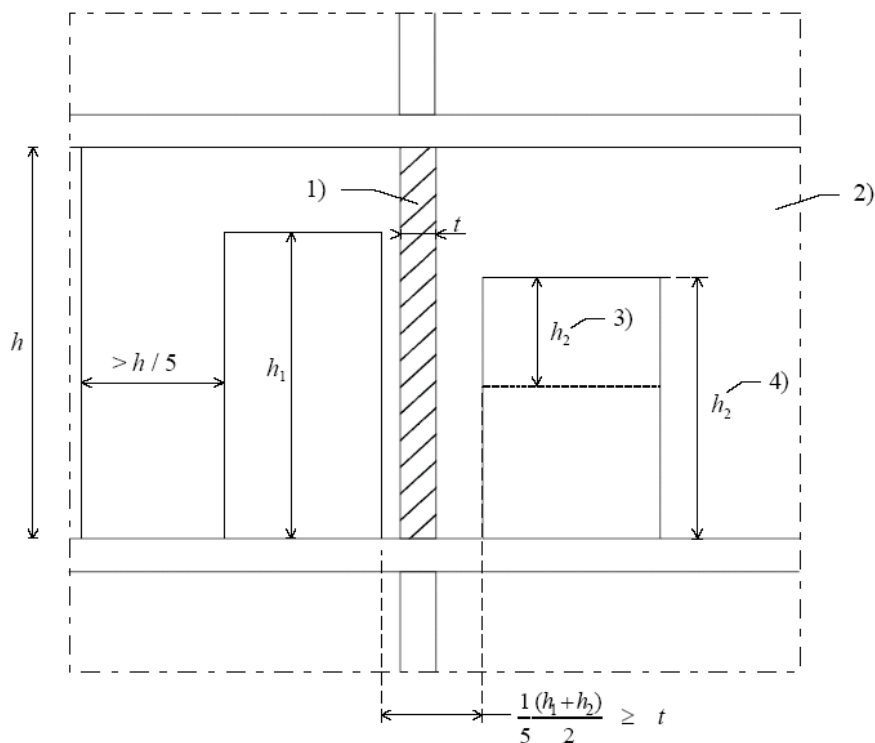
мінімальна довжина підкріплюючої стіни з отворами
